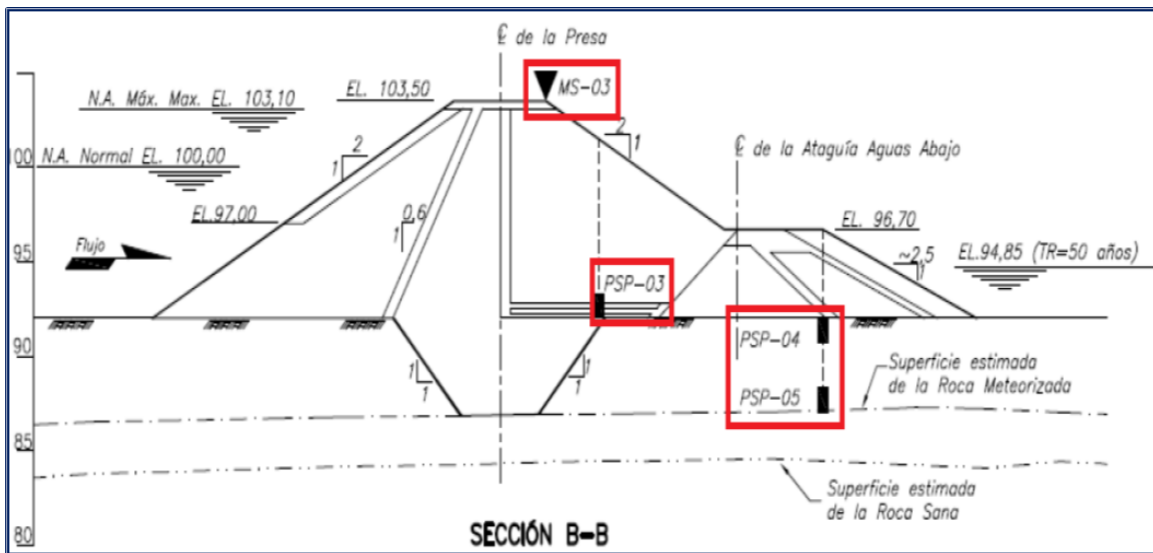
Ubicación de los marcos superficiales y piezómetros en la presa Gualaca- Sección B-B
